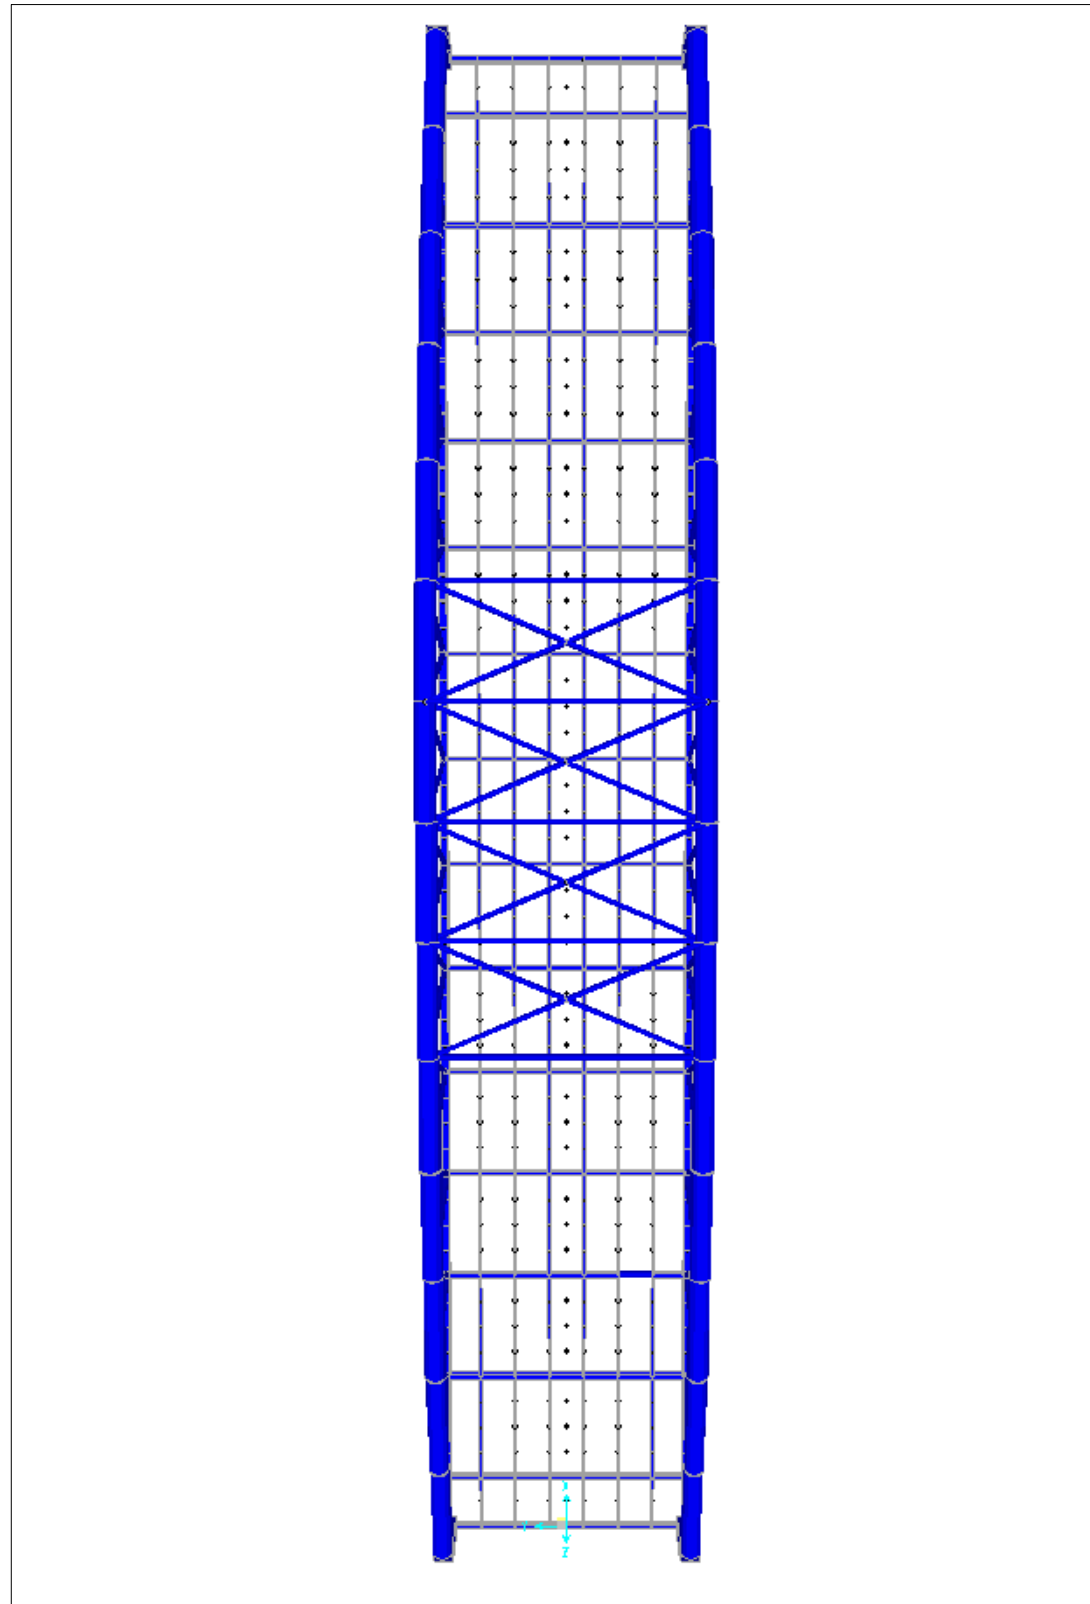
Vista longitudinal modelo Sap2000, vista sin las placas de hormigón (Fuente: elaboración propia)
